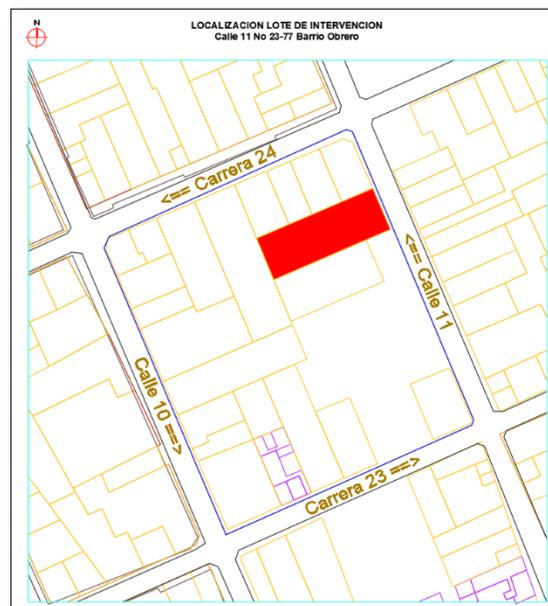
localización lote de intervención proyecto Fourvière (fuente: Plano arquitectónico Edificio Fourvière)
